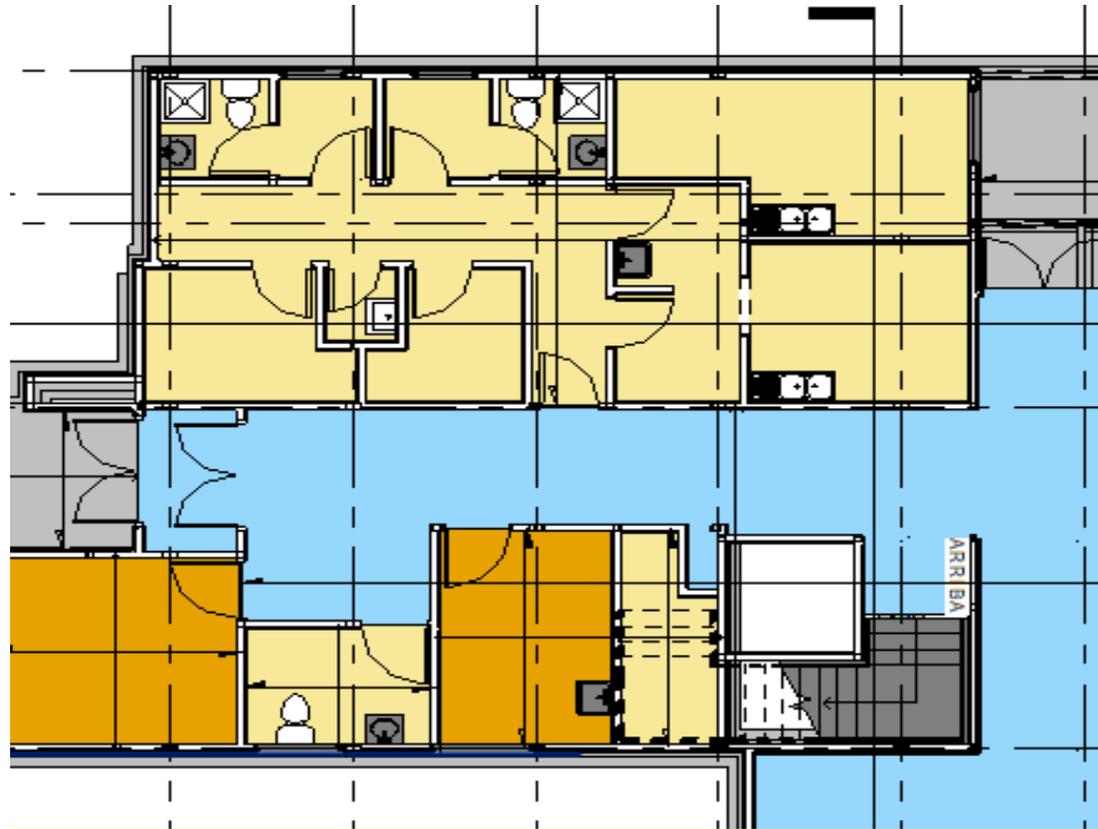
5 Módulos con instalaciones en Planta Baja. Elaboración propia.
